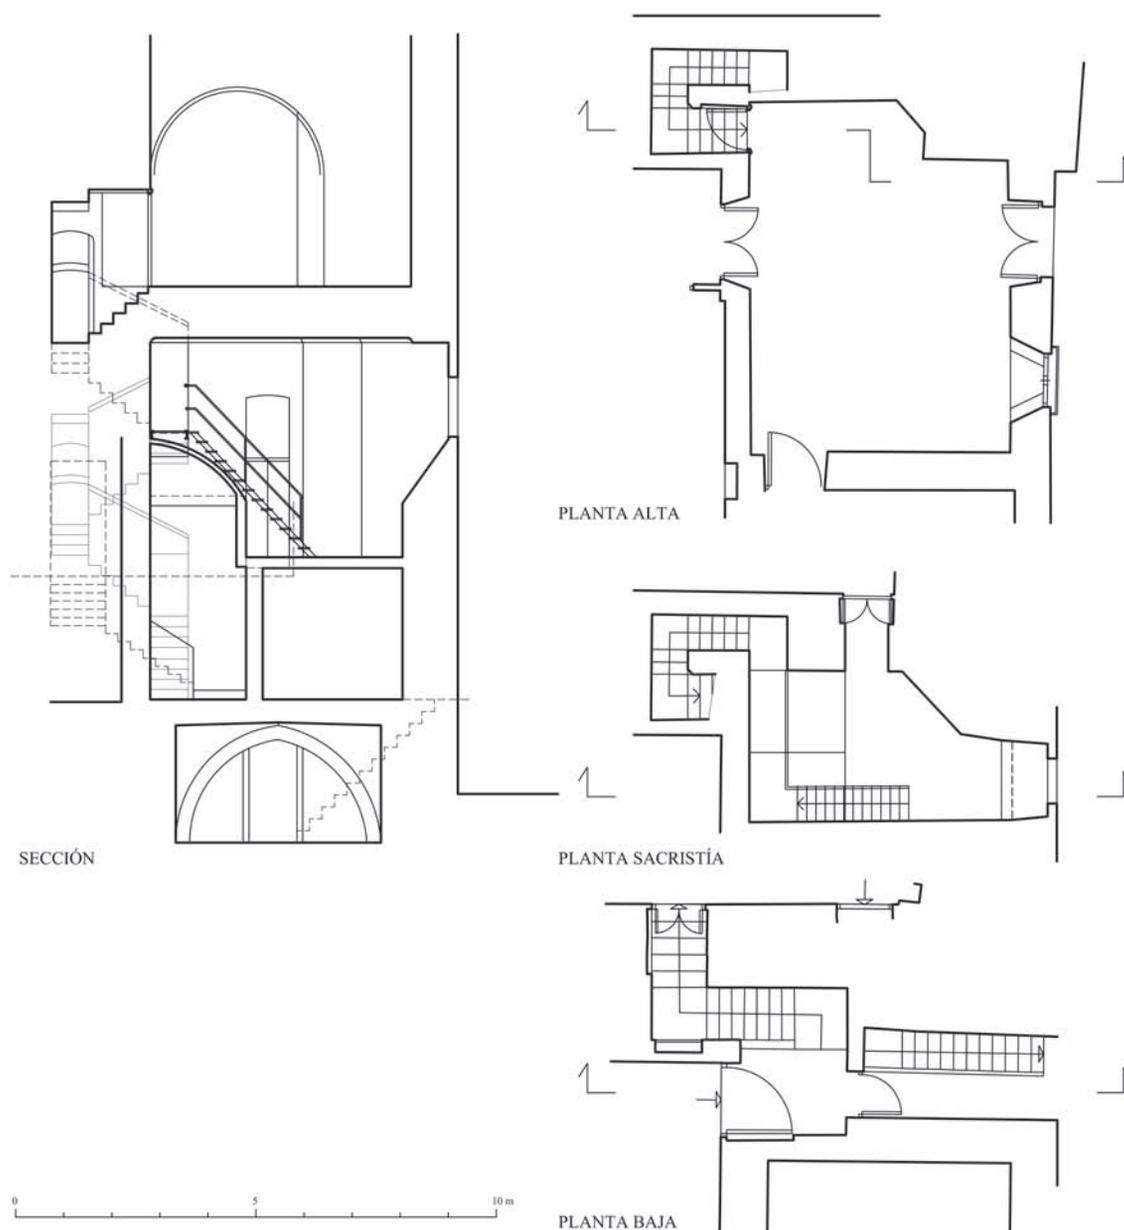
Plantas y sección de la escalera de subida a la planta alta de la crujía sur del palacio de Pedro I. En línea continua fina se representa el trazado original de la escalera y en línea de trazos las partes ocultas de la escalera actual (A. Almagro).
